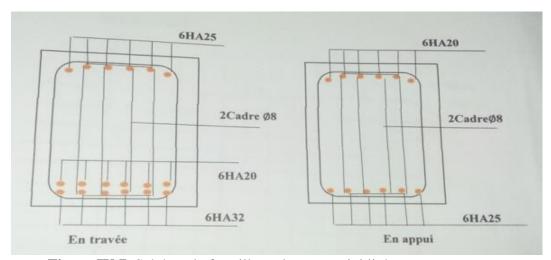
Schéma de ferraillage de poutre rigidité
